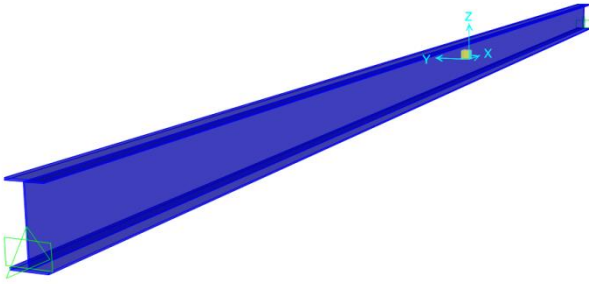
Viga de acero utilizada. Fuente SAP 2000.
